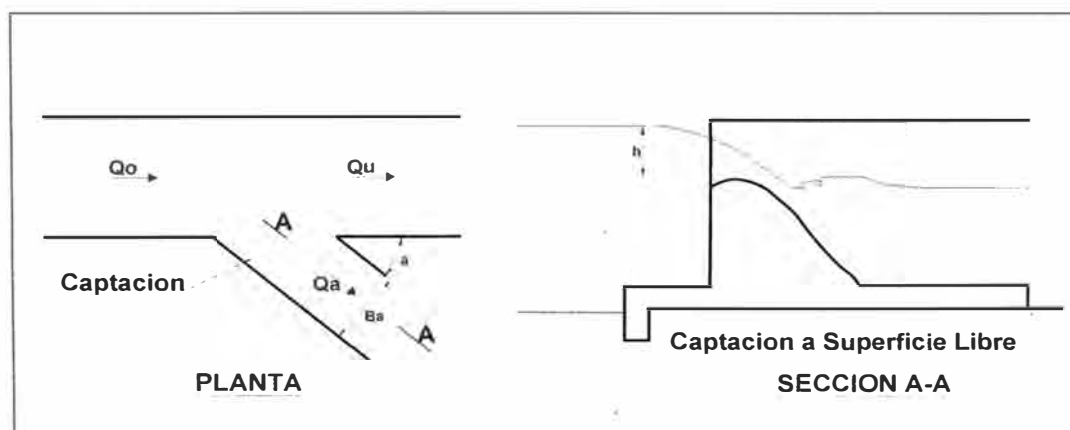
Vista en planta y corte de una Toma de superficie libre
